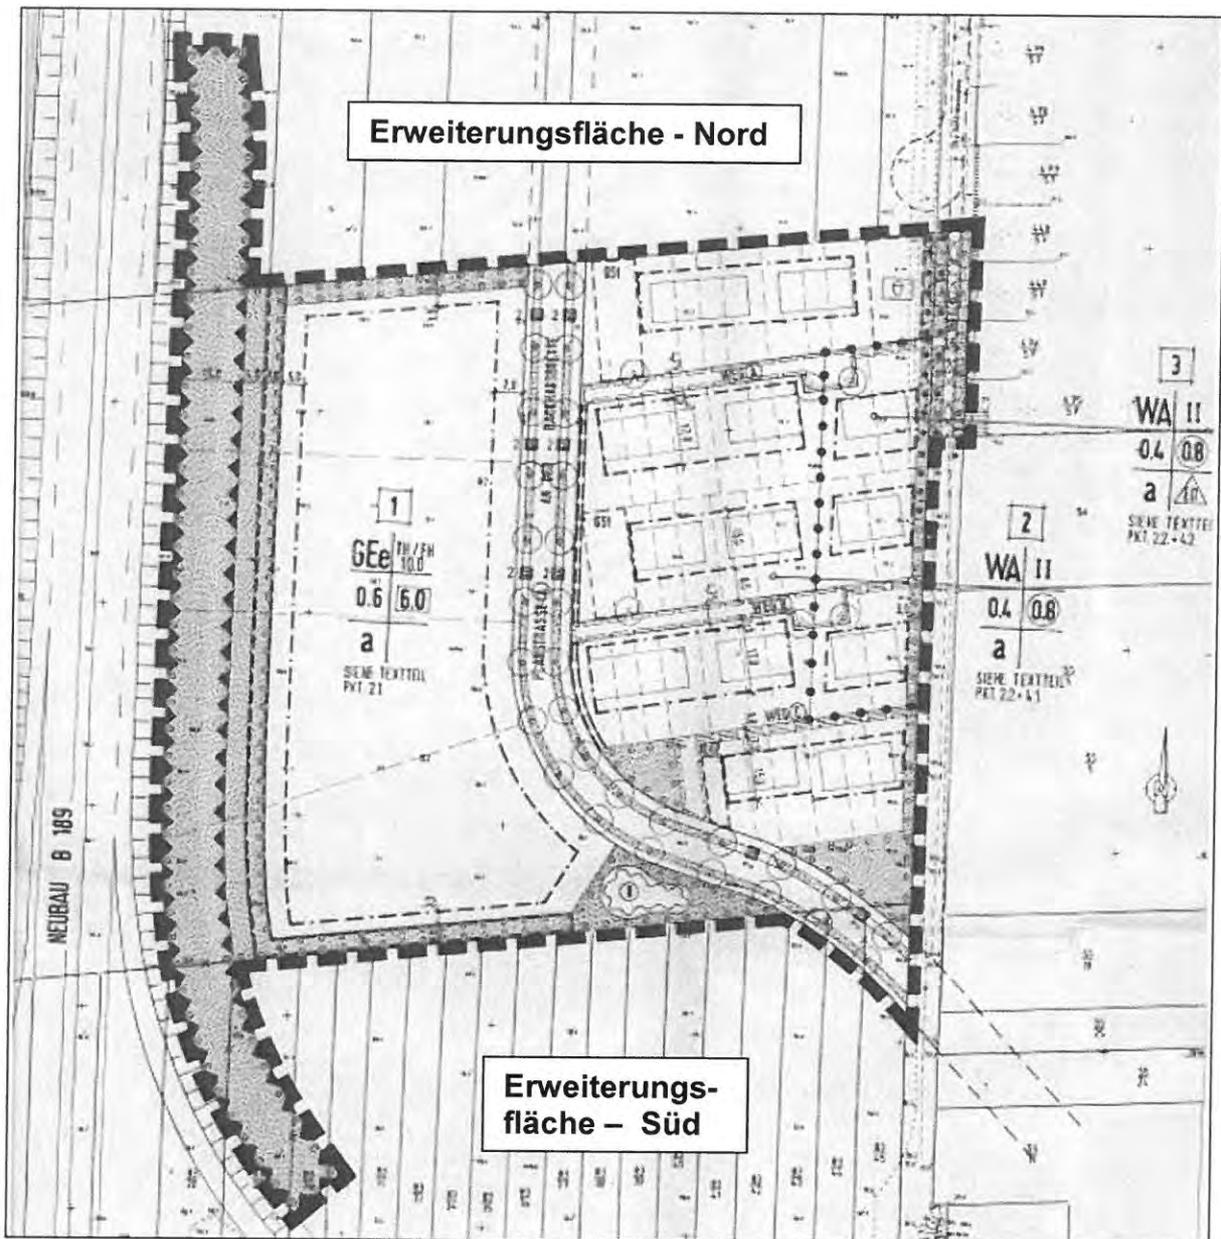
Übersichtsplan für den bisher gültigen Bebauungsplan Nummer 9
